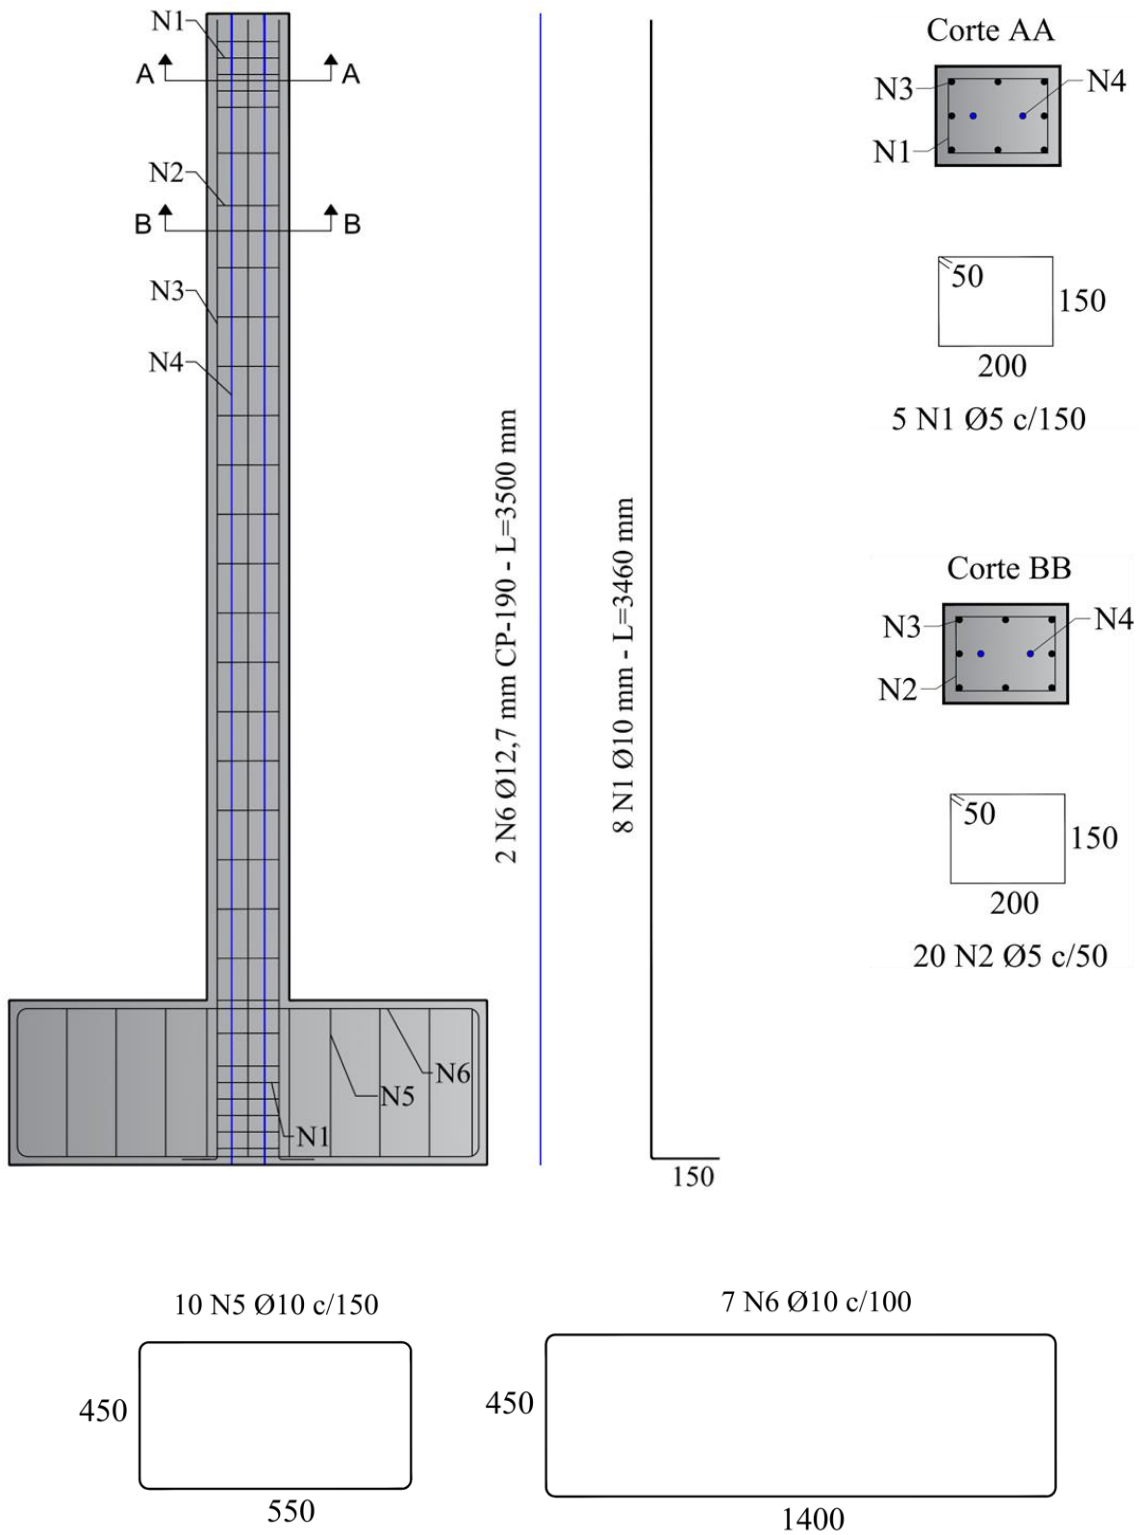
Armaduras do pilar P4 - dimensões em mm (Fonte: Autor)
